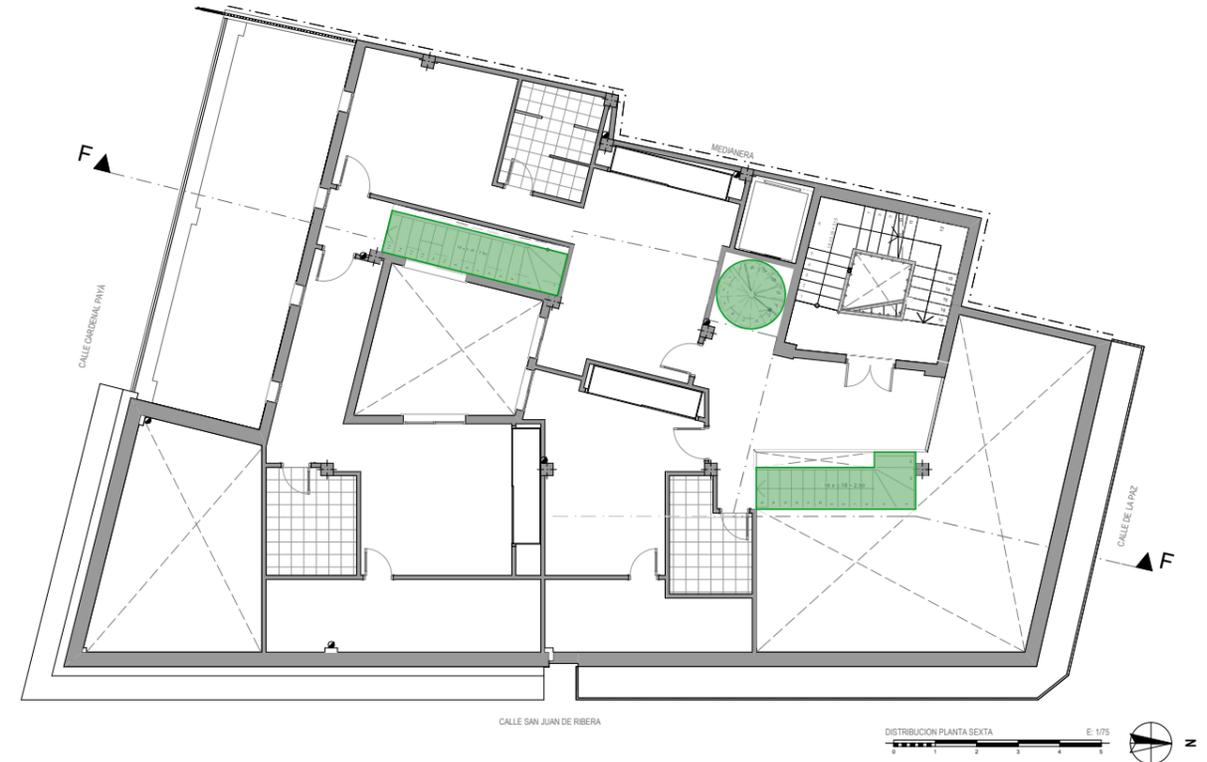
Comunicación vertical privada plantas quinta y sexta.
